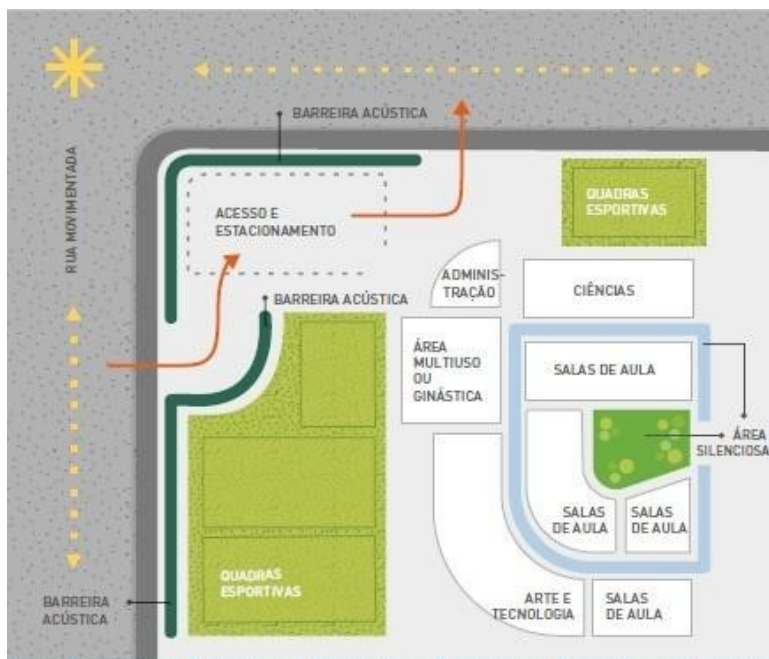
Exemplo de Layout com Fontes de Ruído Afastadas das
